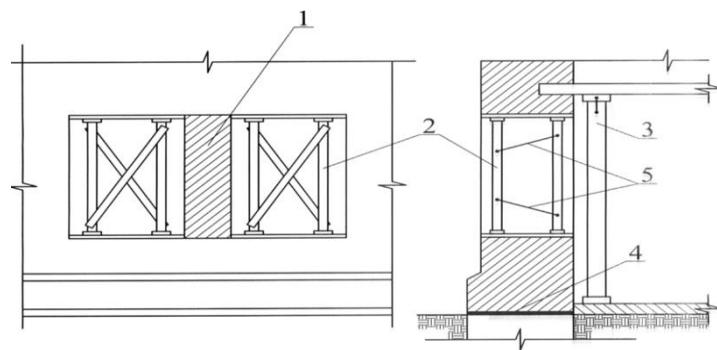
Временное крепление конструкций при перекладке простенка: 1 – перекладываемый простенок; 2 – стойки под перемычкой; 3 - стойки под перекрытием; 4 – гидроизоляция; 5 – строительная скоба
